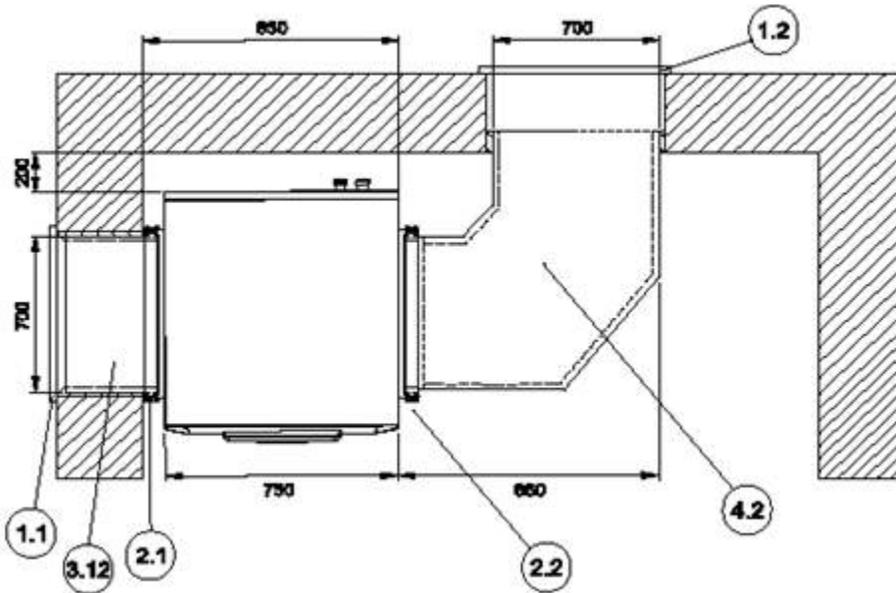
Vista dall'alto - LI 16TES, LI 20TES (installazione a parete - condotto aria lato mandata)
